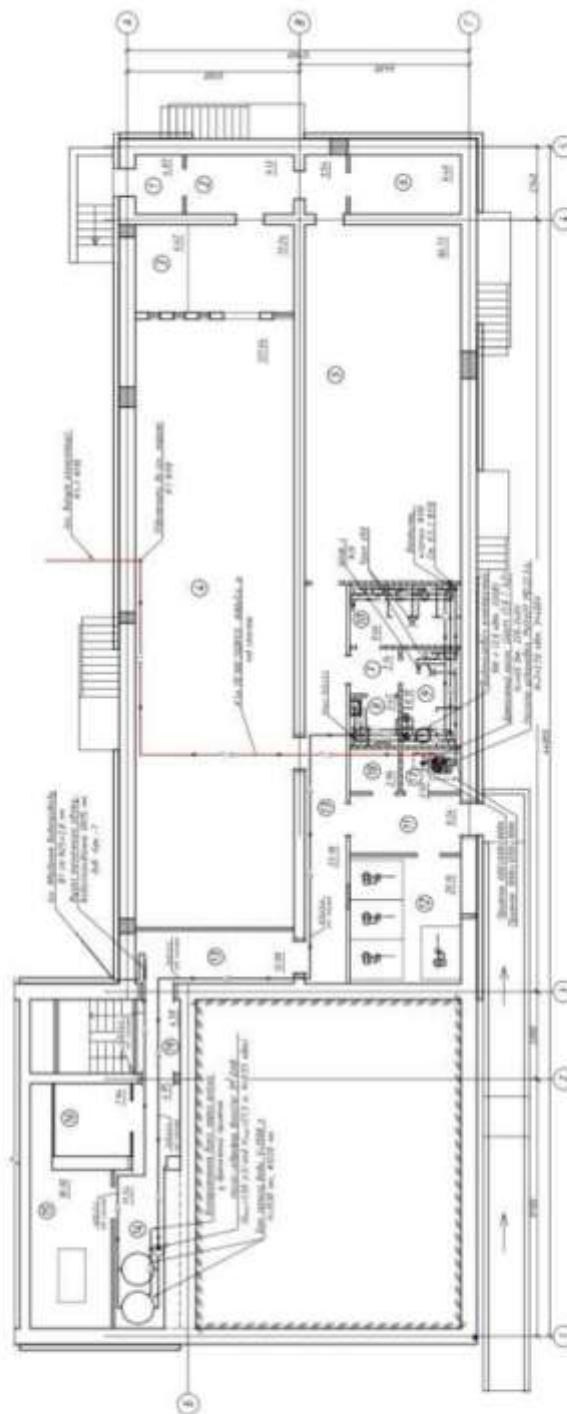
План на відм.0,000 з мережами В1,Т3, К1, К3
